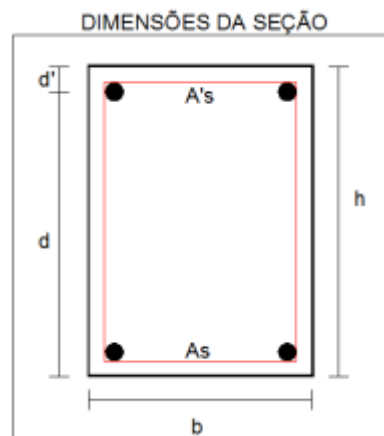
dimensões da seção da viga e posicionamento das armaduras
